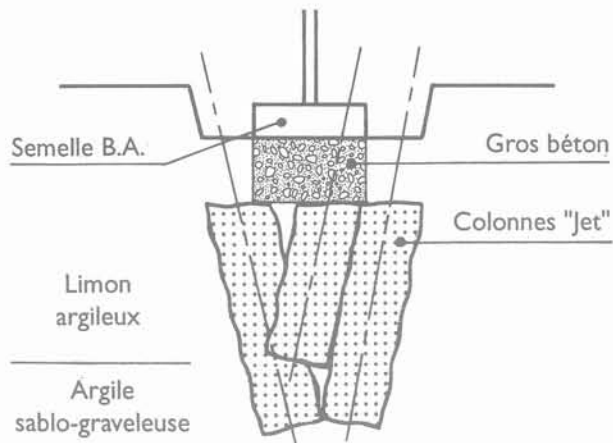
Servas, reprise en sous-œuvre d'un poteau isolé.
